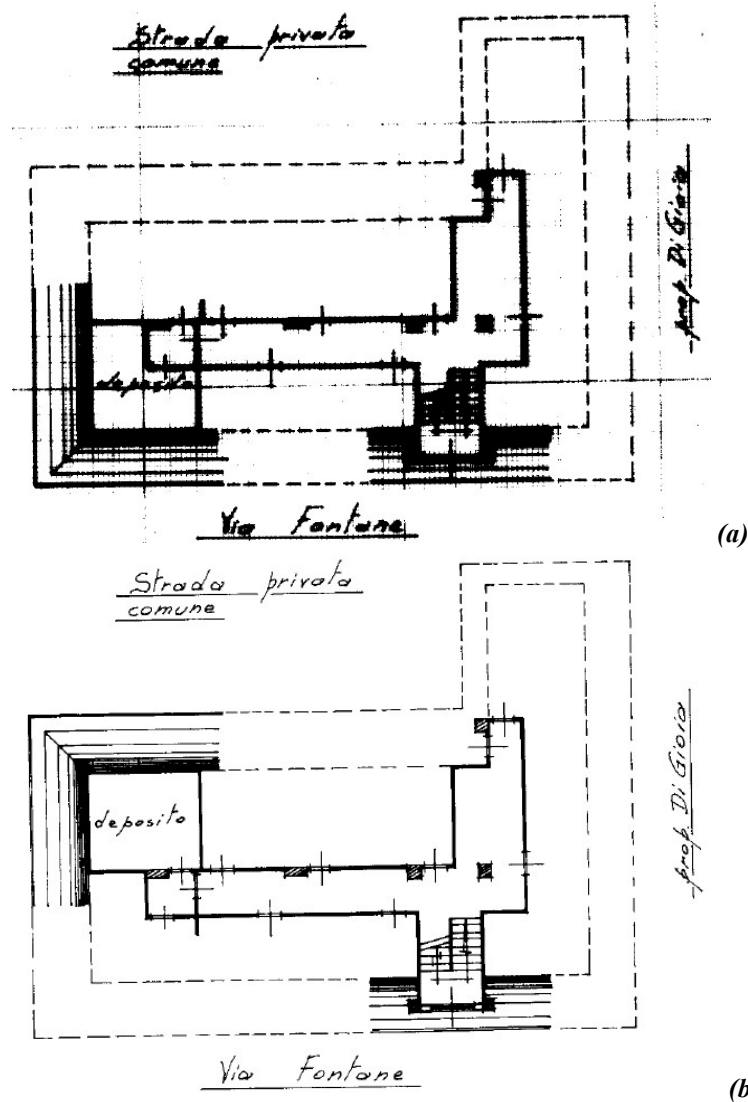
Planimetrie dei locali di sgombero in terzo piano sottotetto ubicati in via Fontane n° 22: interno 12 (a); interno 13 (b).
